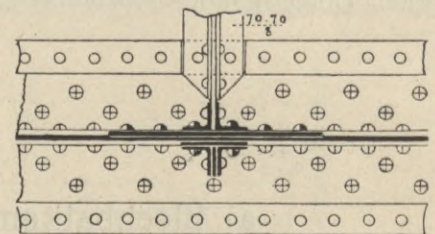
Grundriss der Stossdeckung in einem äusseren Hauptträger.
